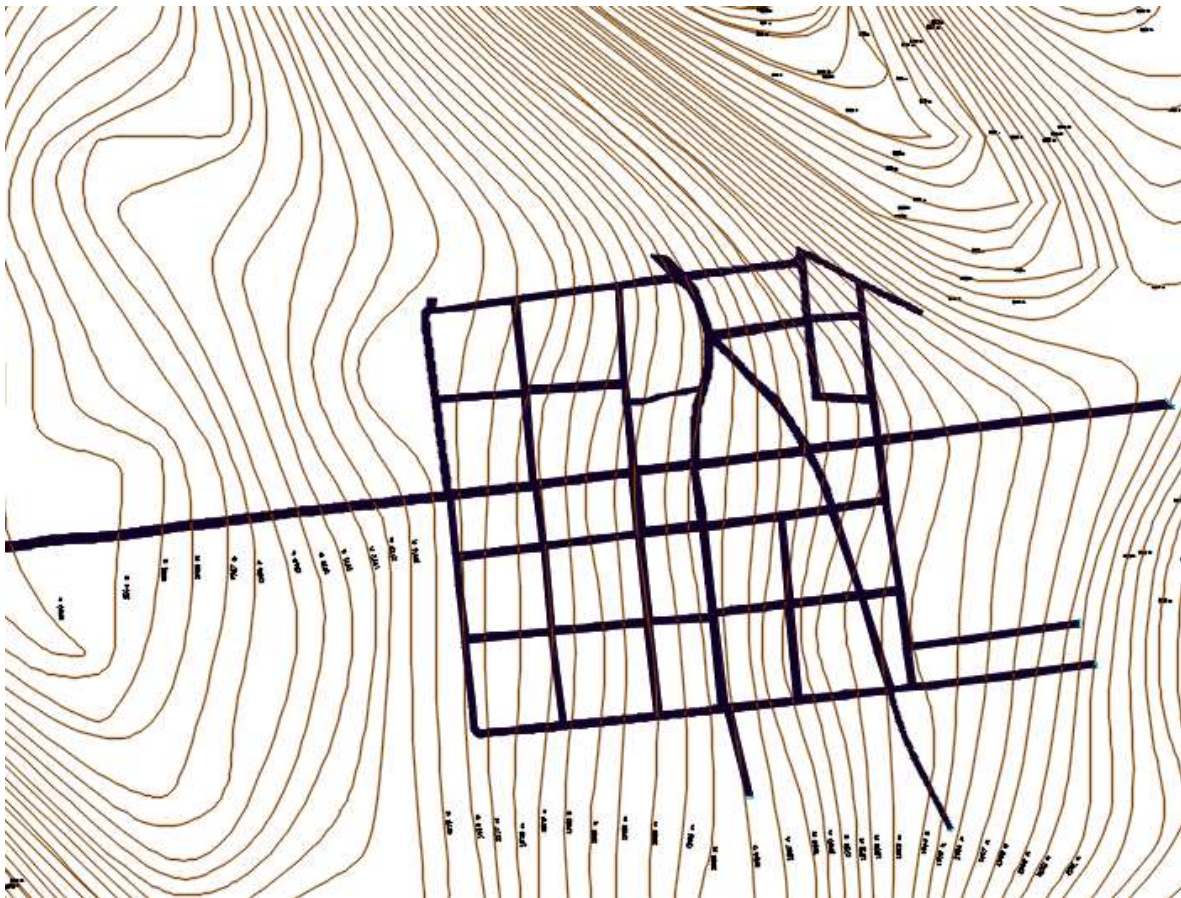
4. Calles con sistema de alcantarillado sanitario.
